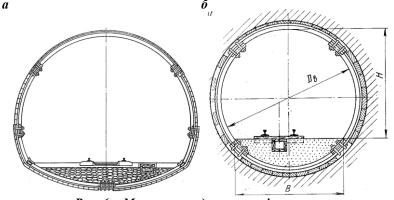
Металеве податливе кріплення: а - зі зворотнім склепінням; б – кільцеве
